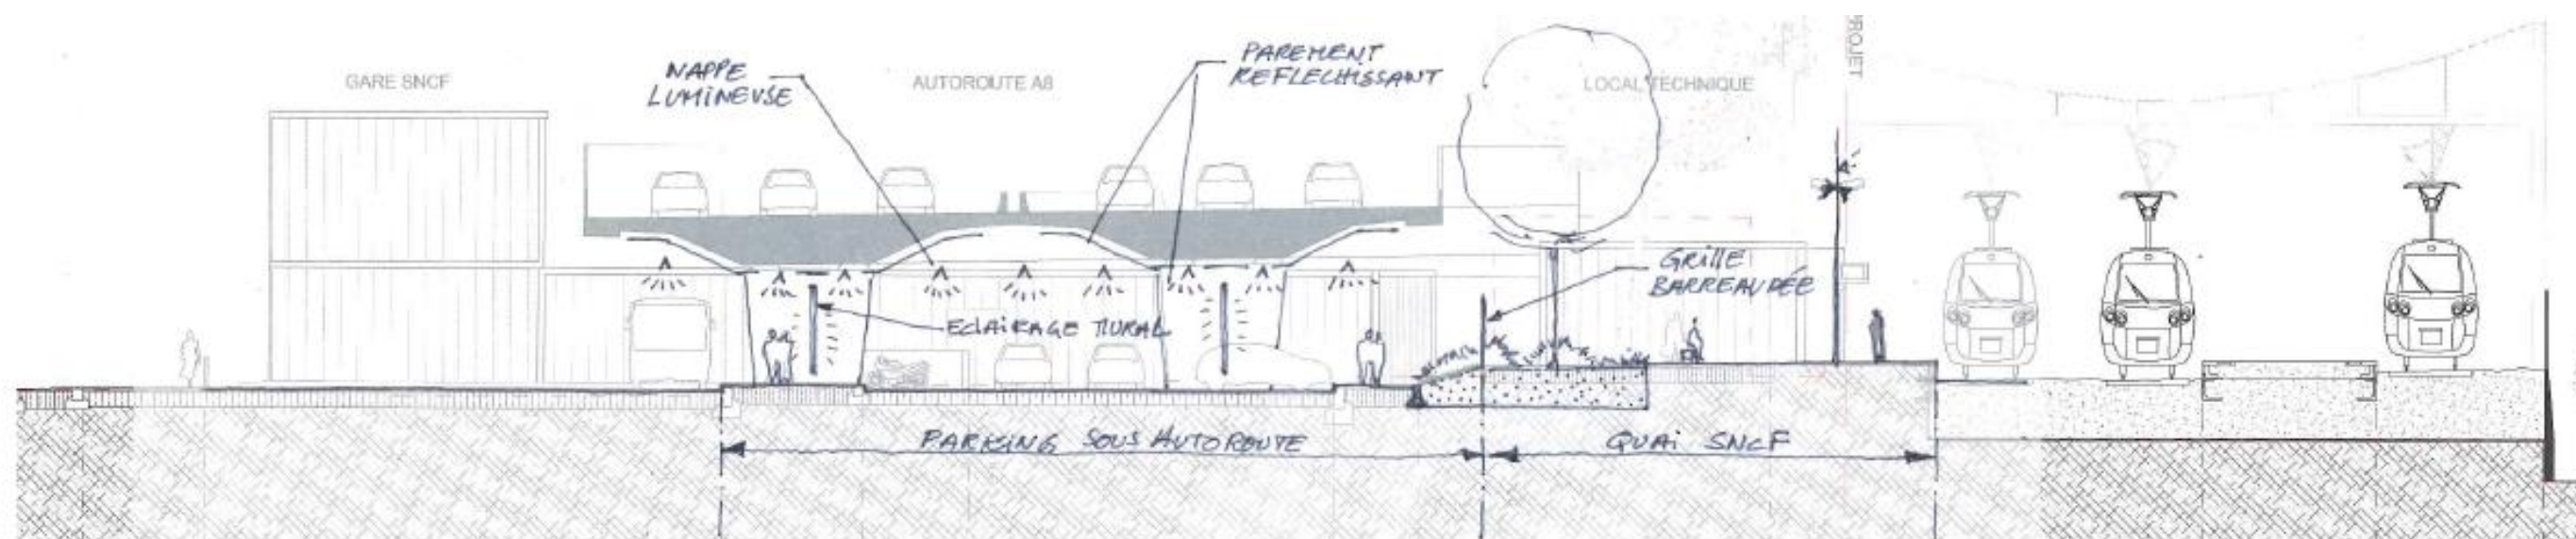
Coupe transversale sur le parking sous autoroute et sur le quai SNCF - Etat Projeté (AREP)
